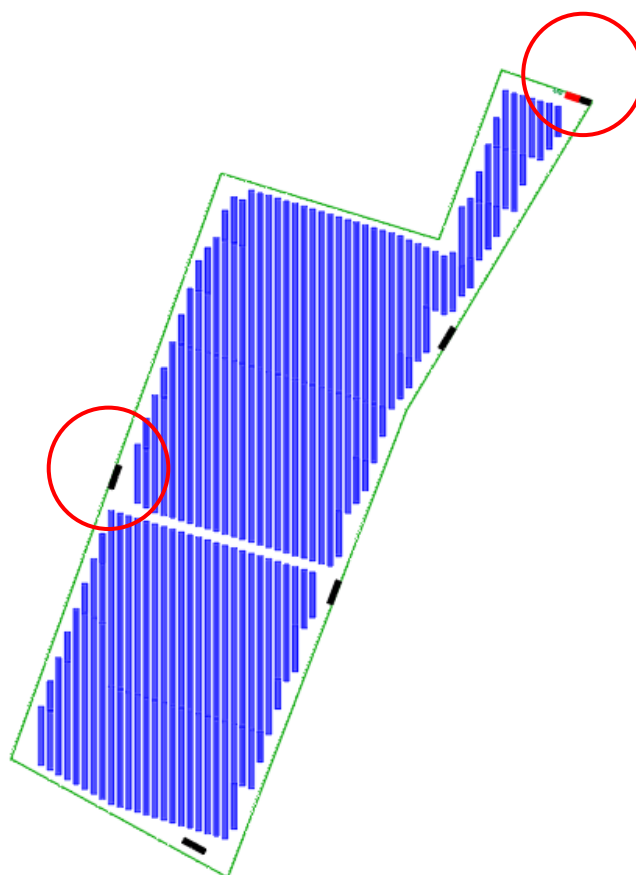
vista planimetrica dell'intervento, individuazione cabine più prossime ai recettori
